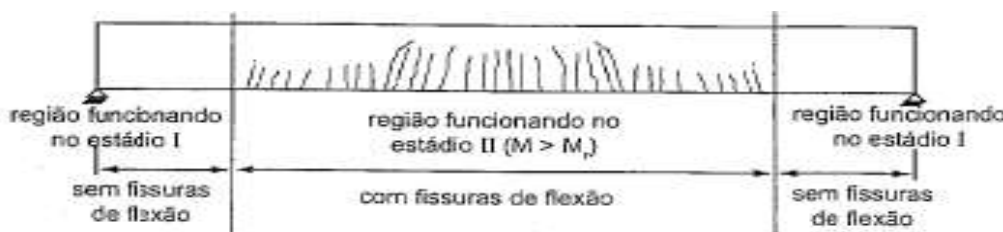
Viga de concreto armado sob flexão em estado de fissuração.
